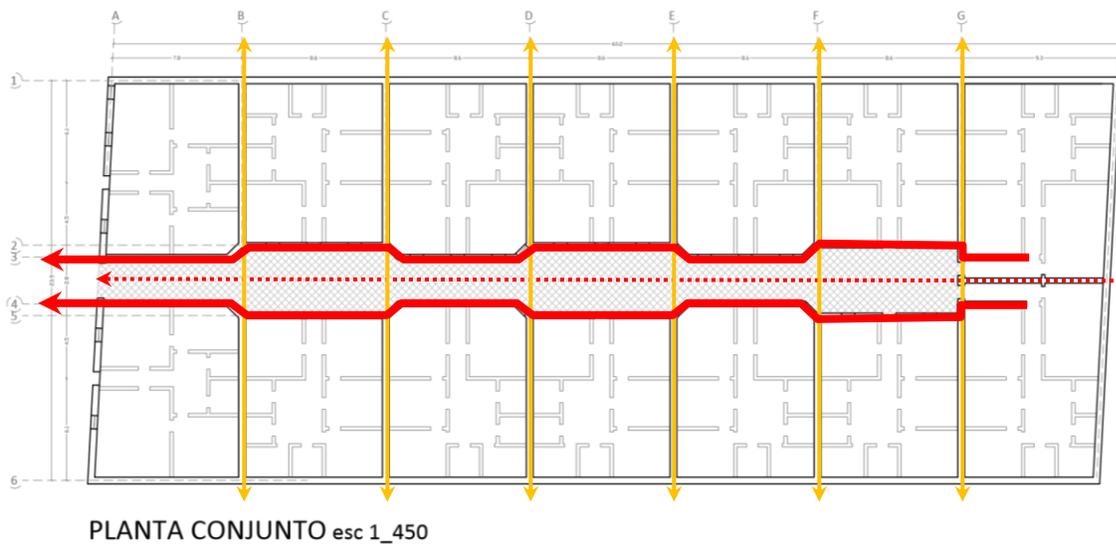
Planta conjunto intervenida, se muestra en rojo los ejes serpenteantes donde se rompe la continuidad de muros y en naranja los ejes verticales.
